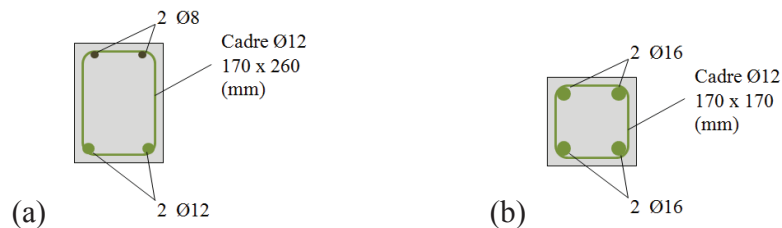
Renforcements de la section (a) de la poutre et (b) du poteau du portique G1
